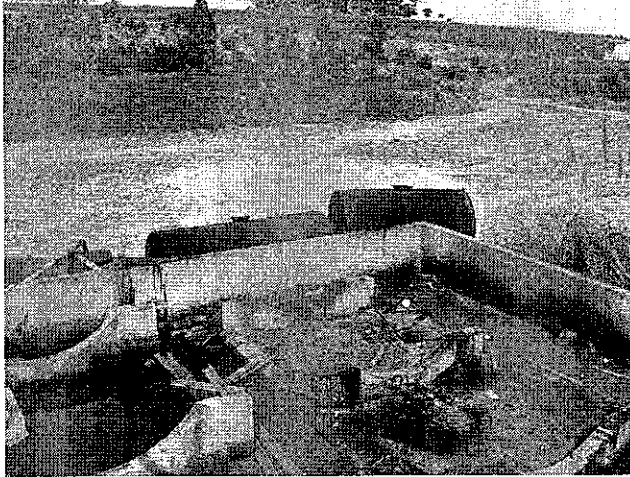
Jazida J5 no lote 27/SC necessitando de finalização do desmonte das estruturas de descarregamento de CM30.
